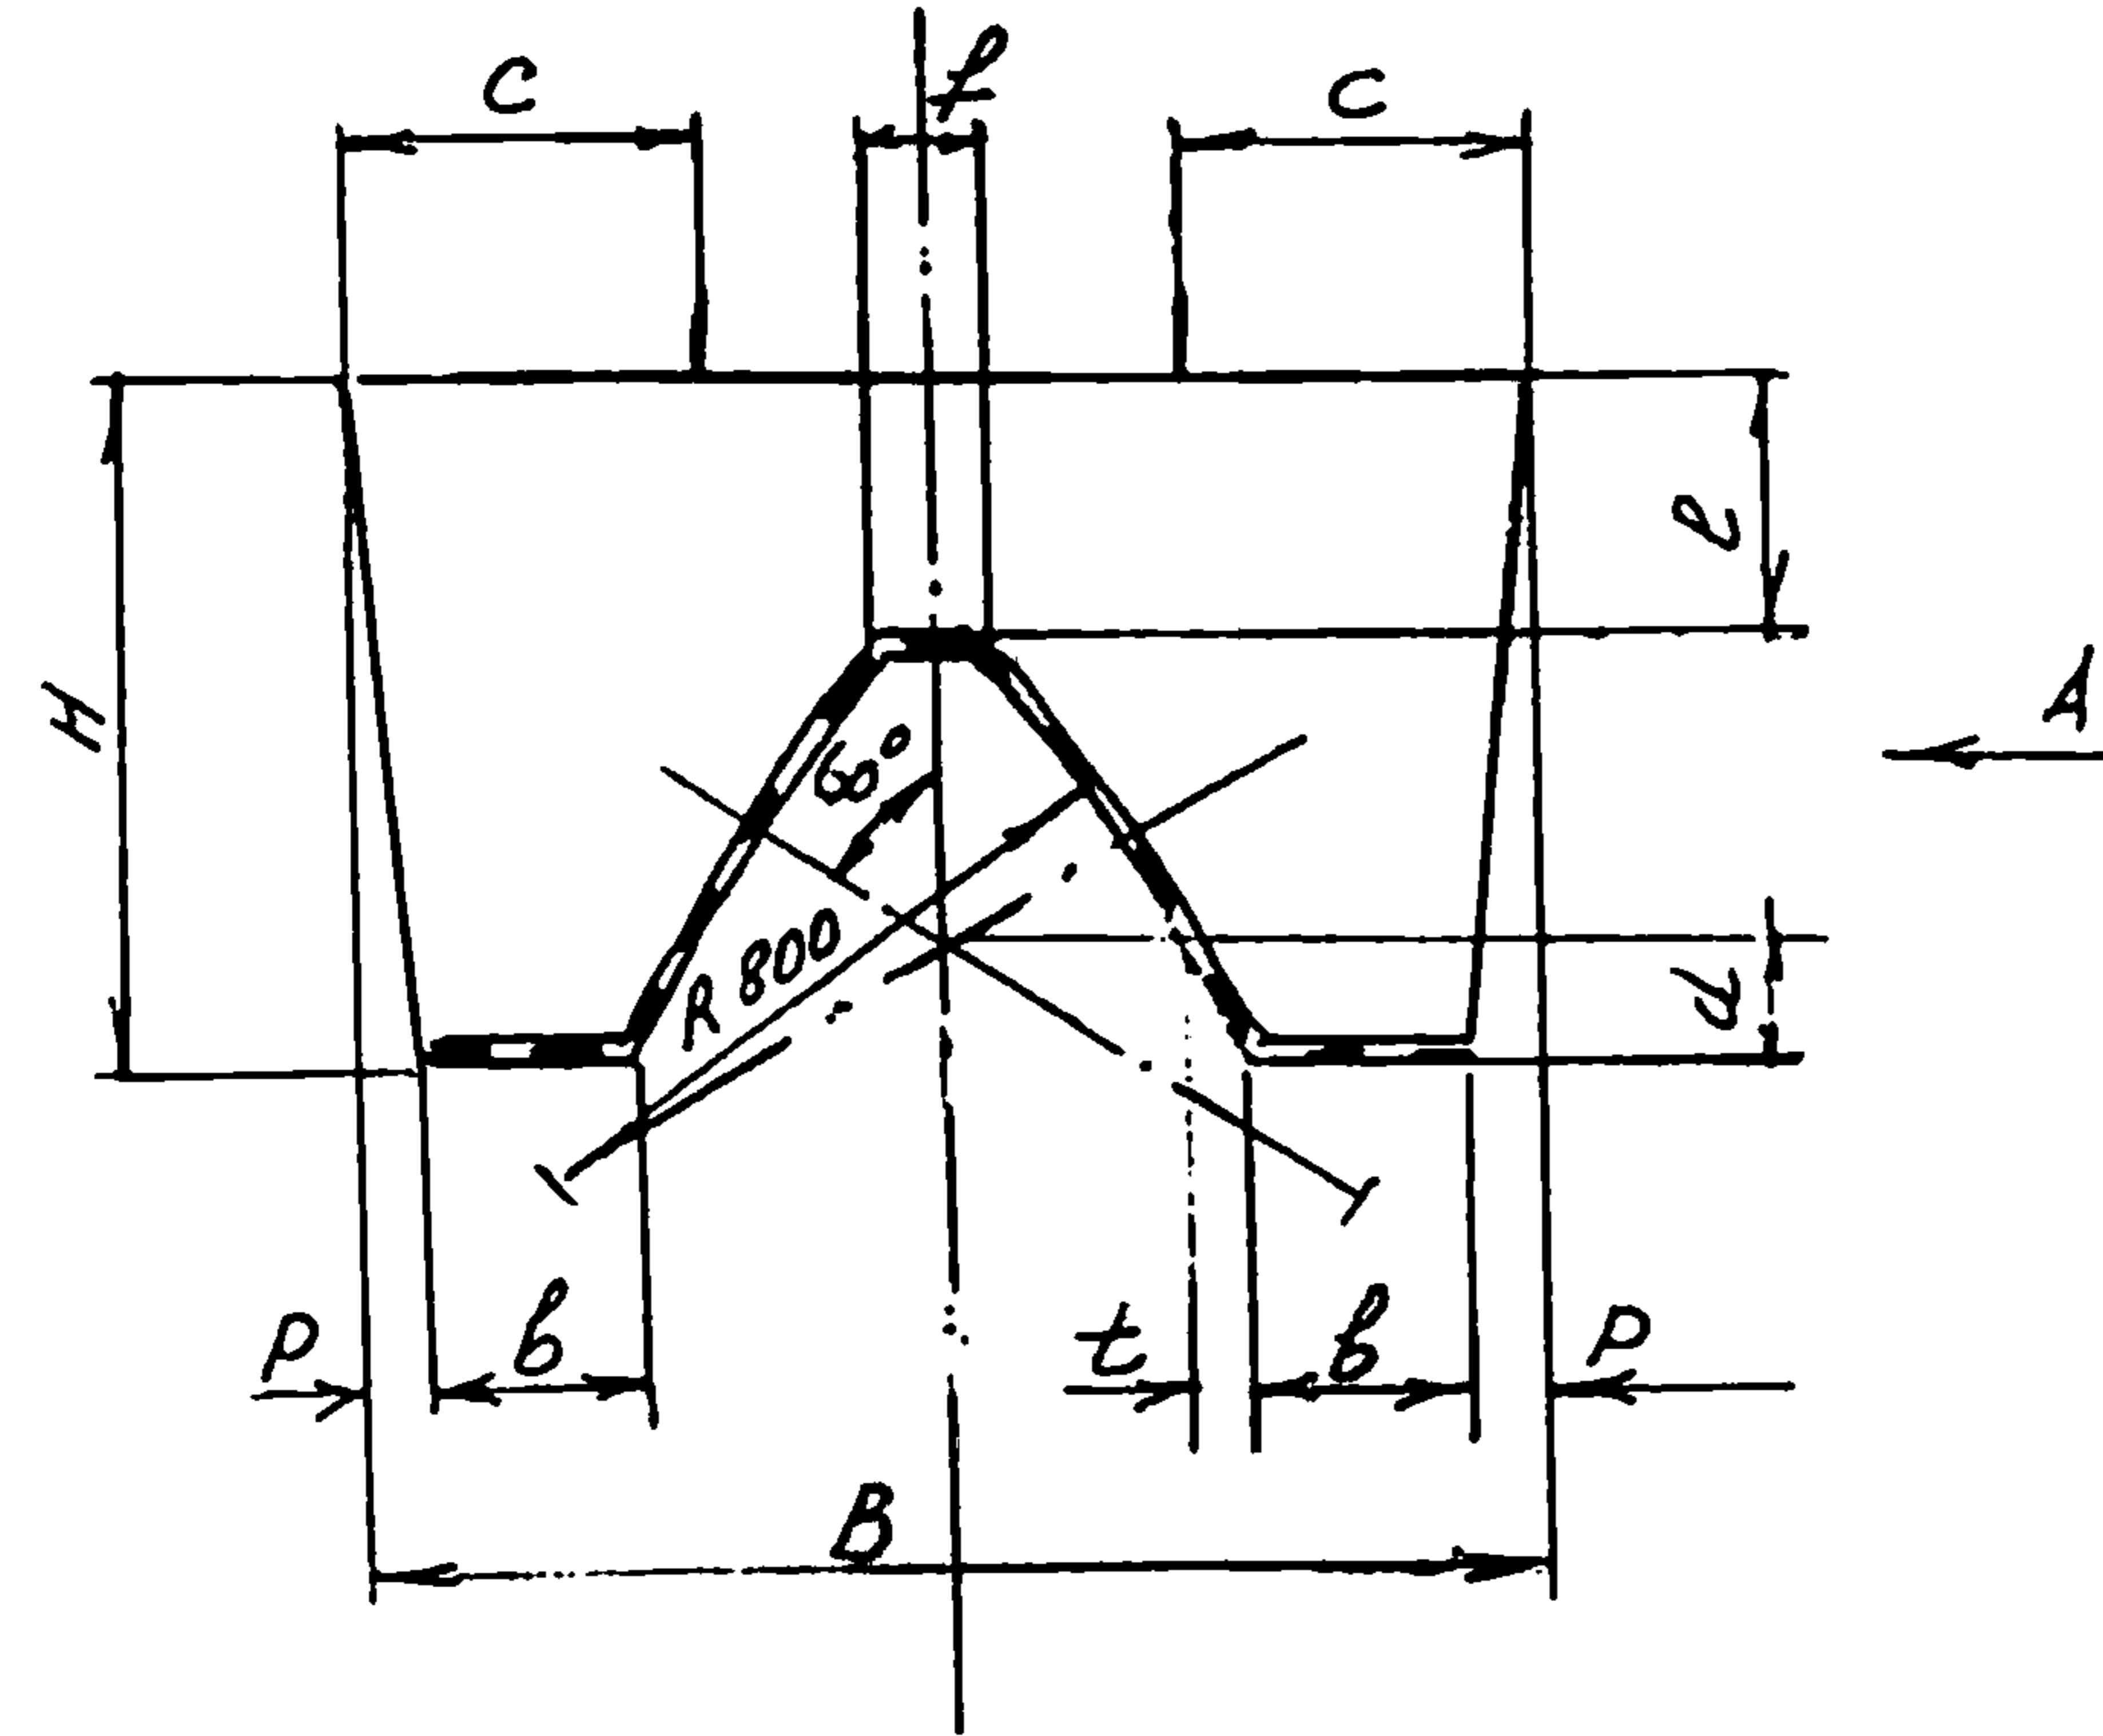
Общий вид узла крепления марки 1 ЧБКМ
